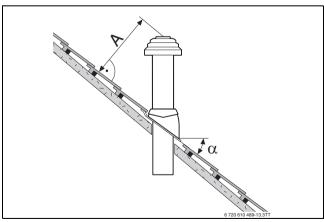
Abstandsmaße und Dachneigungen bei Schrägdach
